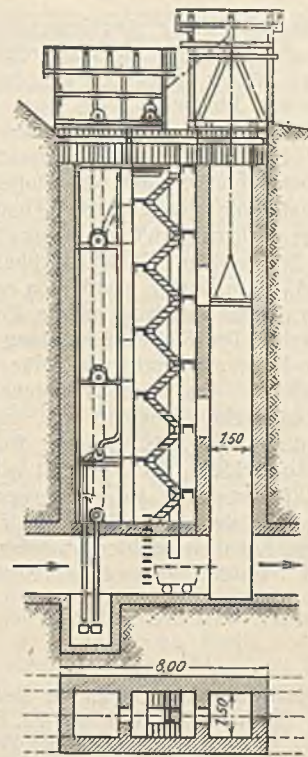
Wasserkraftanlage Kander. Schachtanlage für Stollenvortrieb.
